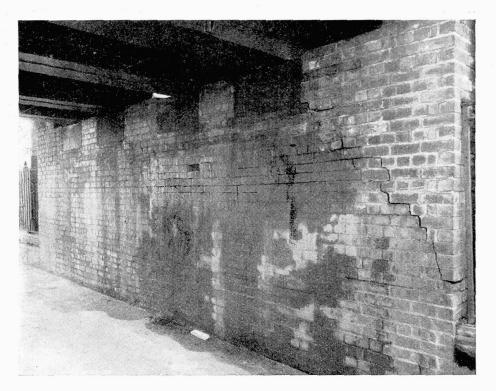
Gerissenes Widerlager. — Culée fissurée. — Fractured abutment.
